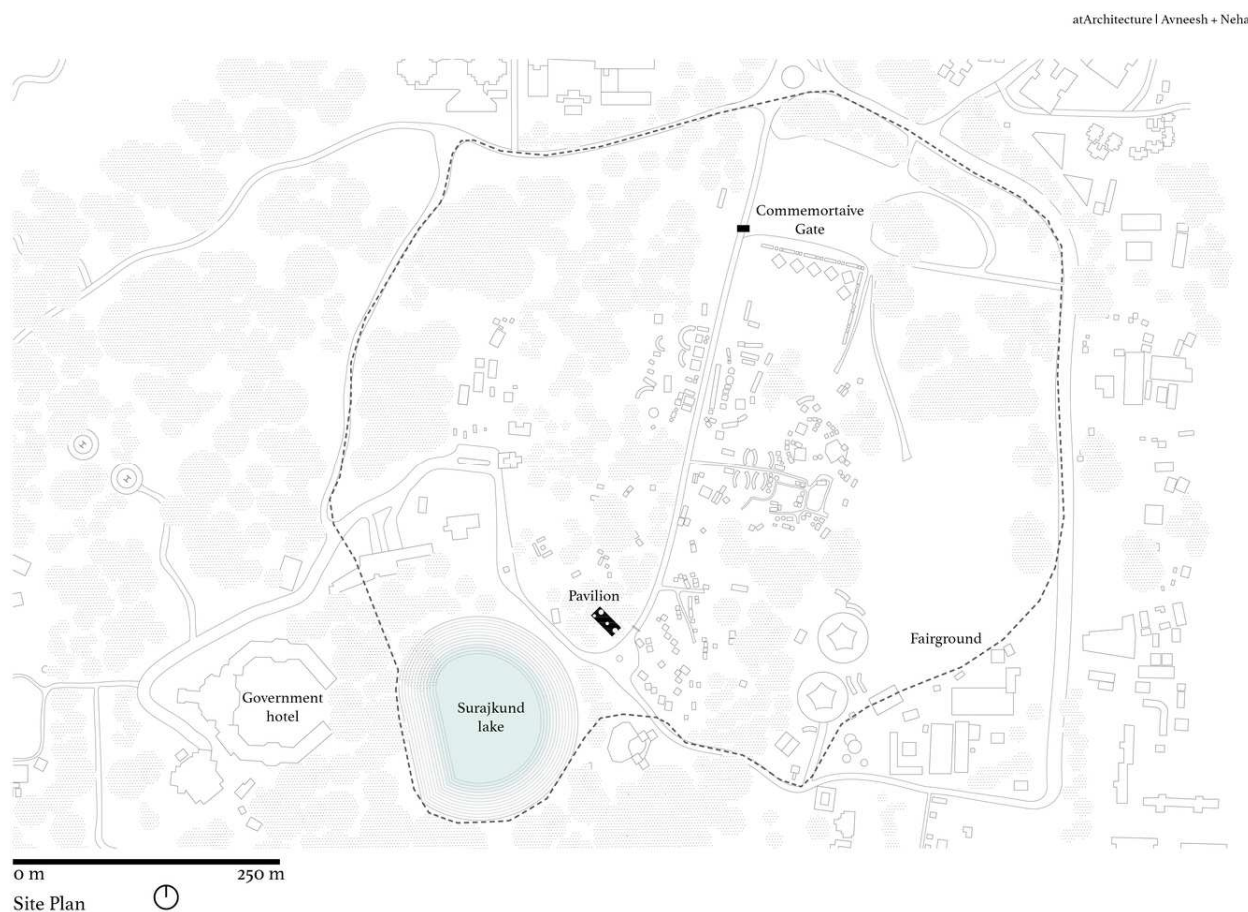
Plan de site du Northeast Bamboo Pavilion.
